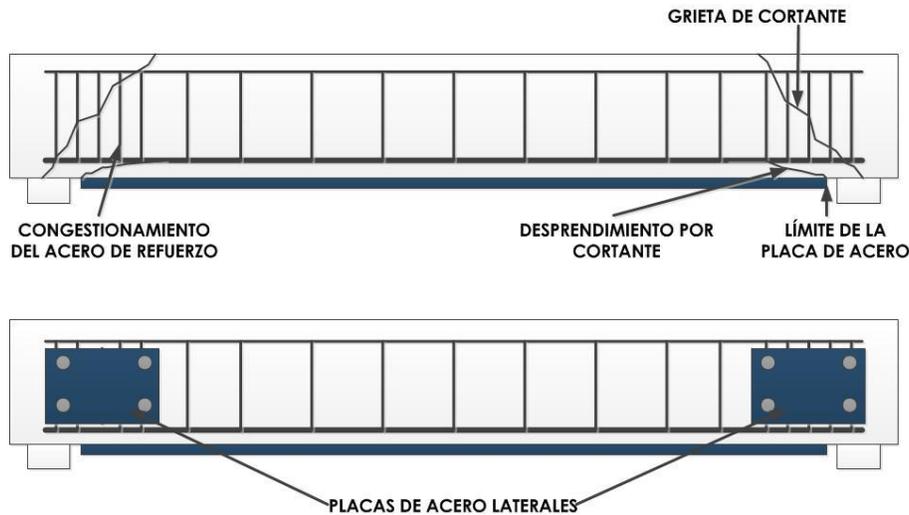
Placas de acero colocadas en las caras laterales (Ryall, 2001)
